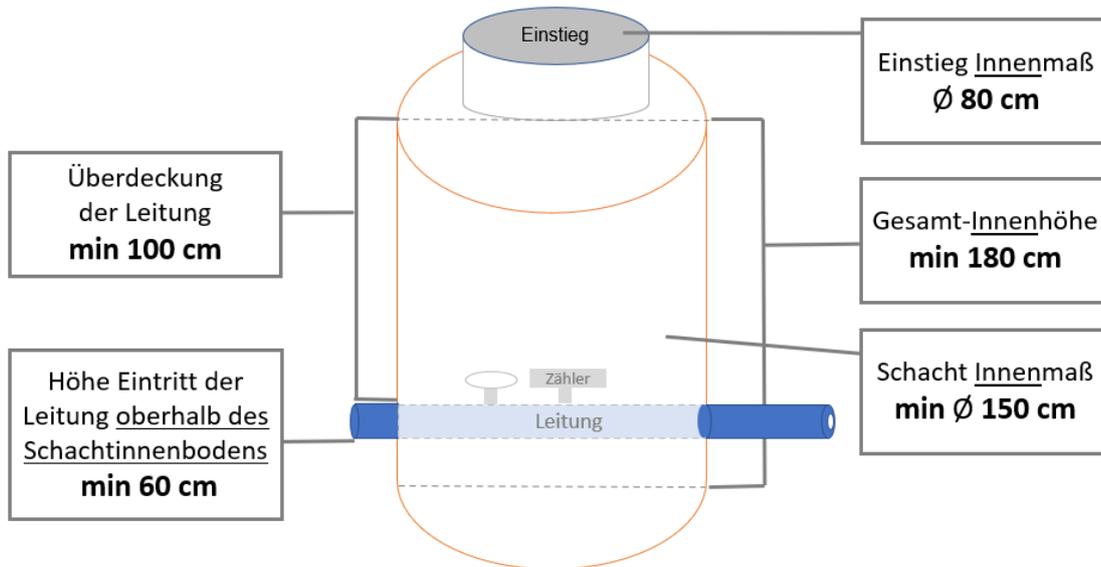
Runder Betonschacht als Übergabe- und Zählerschacht
